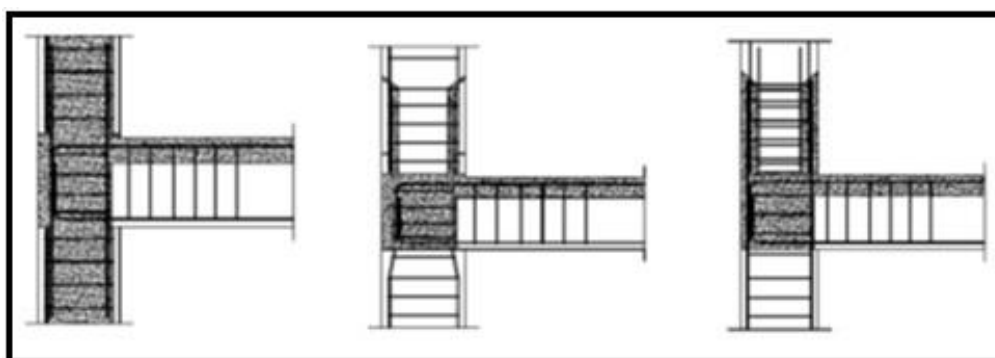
Ligação Pilar – Pilar ao nível do piso, com interferência de viga [2]
